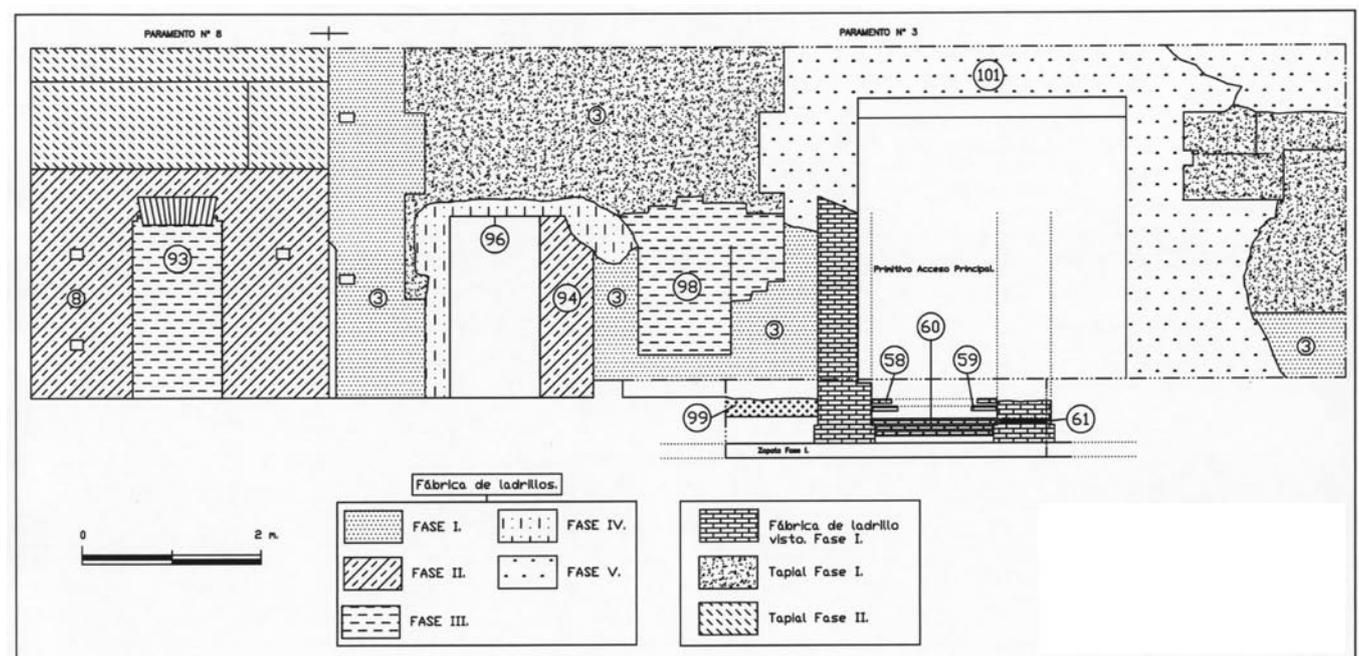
Paramento central (nº 8 y 3). Planta baja. Alzado sur. Análisis estratigráfico con diferenciación de fases constructivas.
